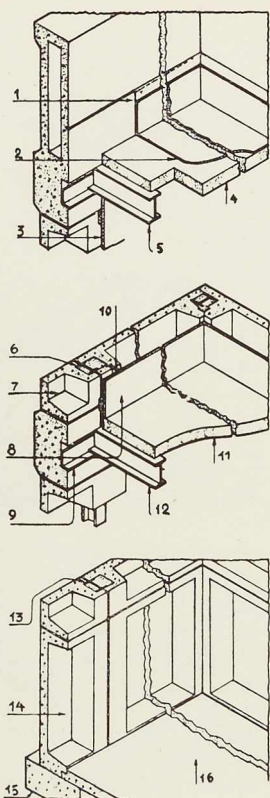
LÉGENDE. 1. Couvre-joint. 2. Couverture de toiture. 3. Panneau de mur en bois ou panneau en béton de cendrée. 4. Dalle en béton ou plancher en bois. 5. Solive de toiture en acier. 6. Montant en acier. 7. Panneau léger (largeur 1^m22, hauteur 2^m74). 8. Panneau de mur en bois ou panneau en béton de cendrée coulé à l'avance. 9. Cornière continue. 10. Latte de fixation. 11. Dalle en béton ou plancher en bois. 12. Solive en acier. 13. Montant en acier prenant appui sur fondation en béton. 14. Panneau en béton, de 2^m74 de haut. 15. Fondation en béton. 16. Plancher en béton.
